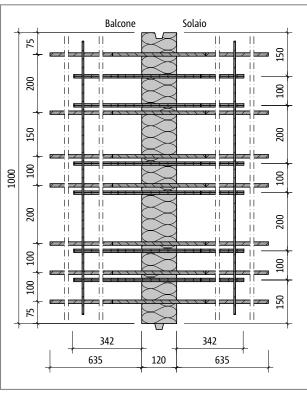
Schöck Isokorb® tipo DXT per CV35: sezione dell'elemento
